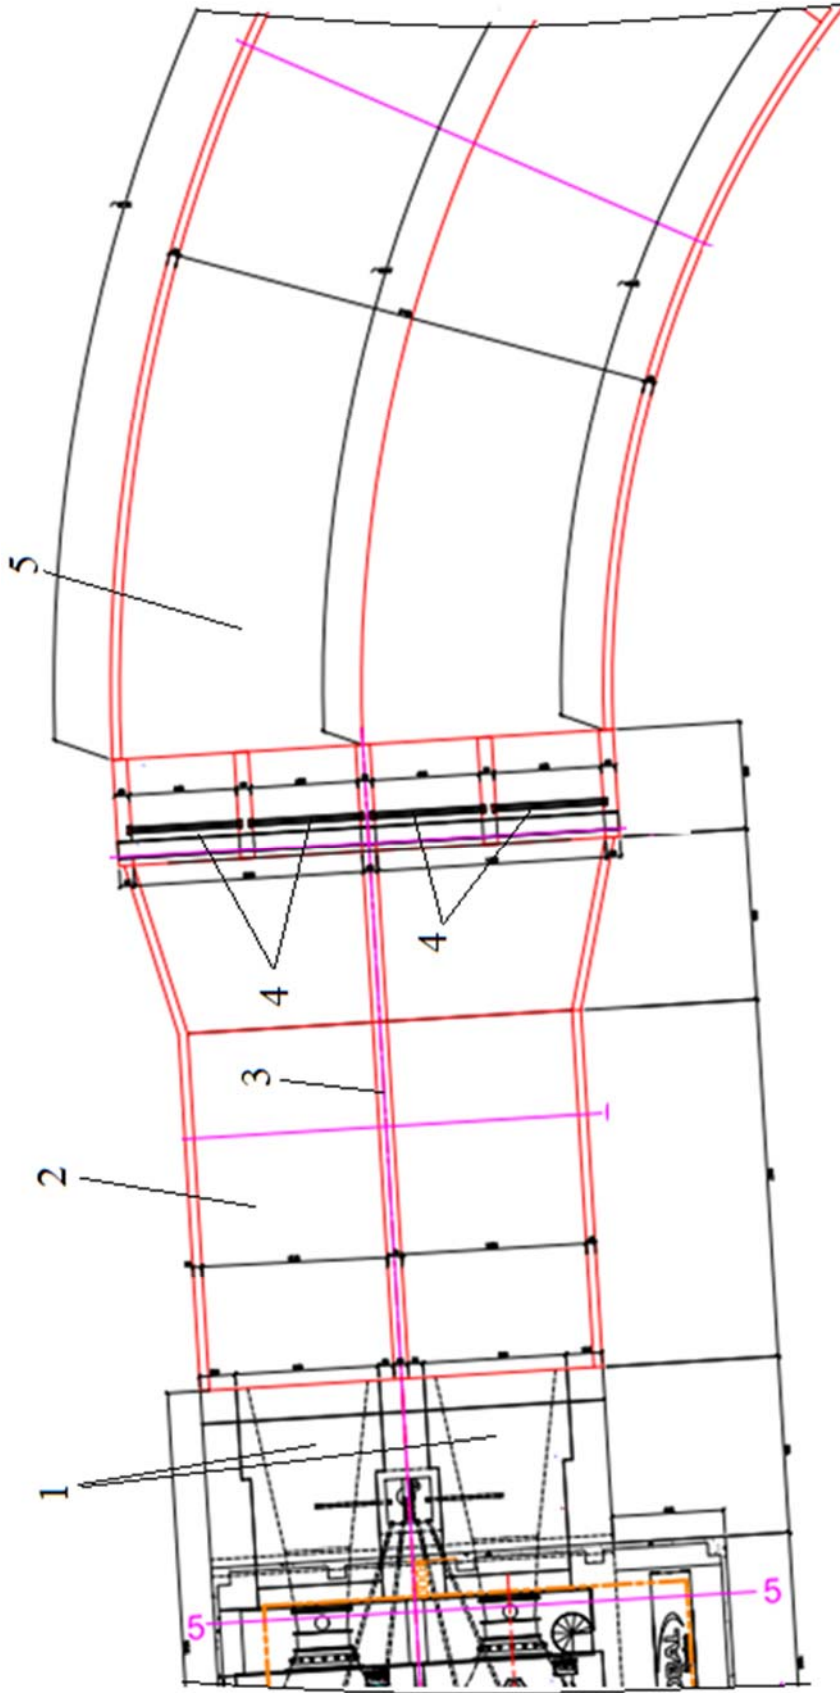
План сопряжения водопроводящих элементов здания МГЭС (отсасывающих труб) с отводящим каналом:
